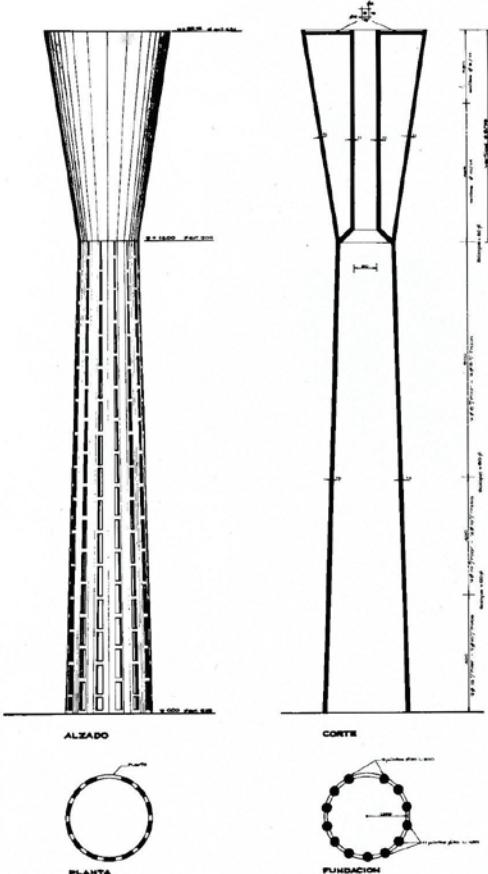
Vista lateral e corte onde se observa a passagem por dentro da caixa d'água para a limpeza. (*- 3).
